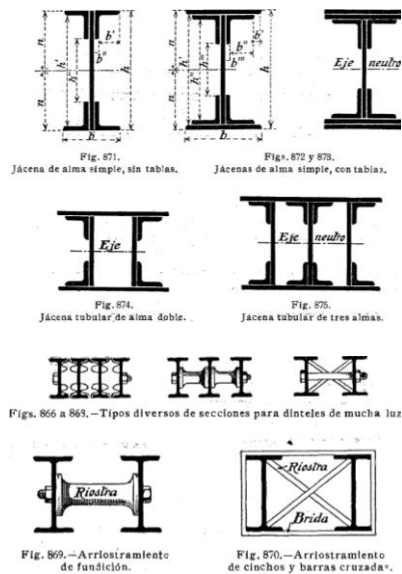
Estructuras de cargaderos metálicos en planta baja, o 'petrales'. Tratado de Étienne Barberot, 1906
